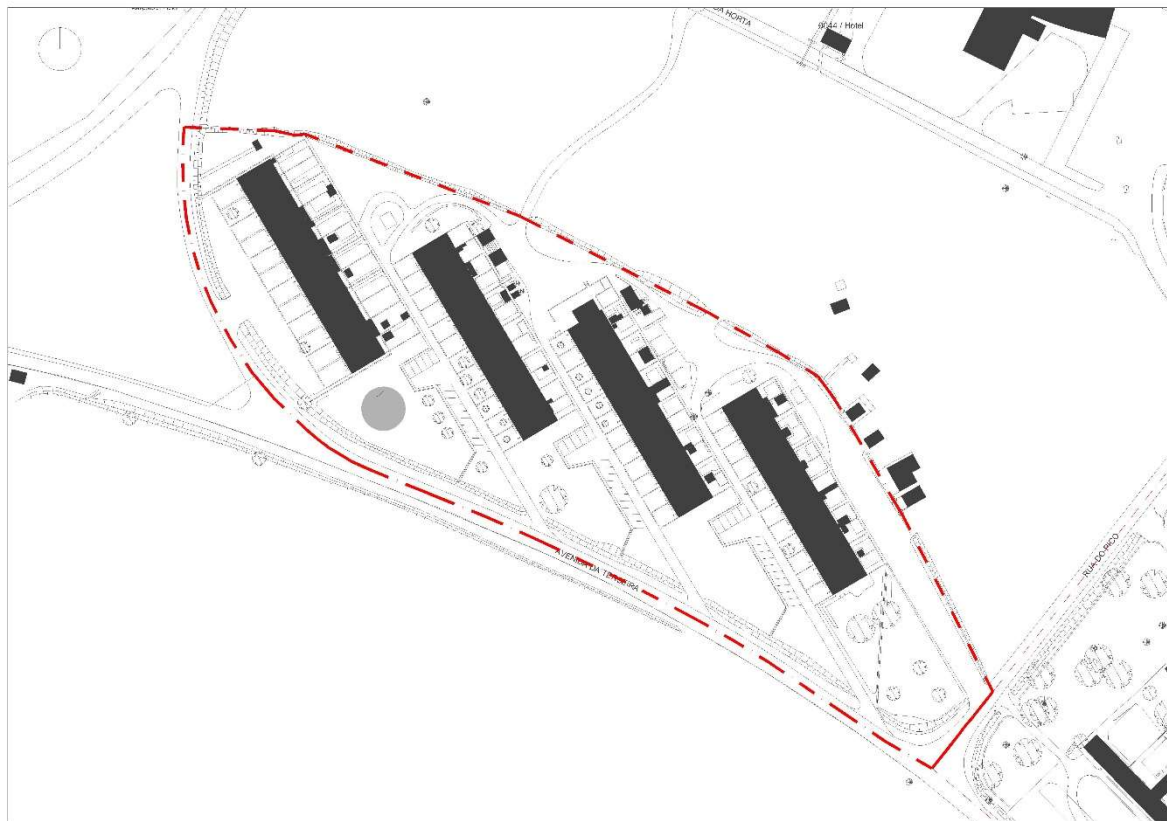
Planta do Bairro dos Anjos (Extrato de Planta Cedida Pelas Ilhas de Valor)
